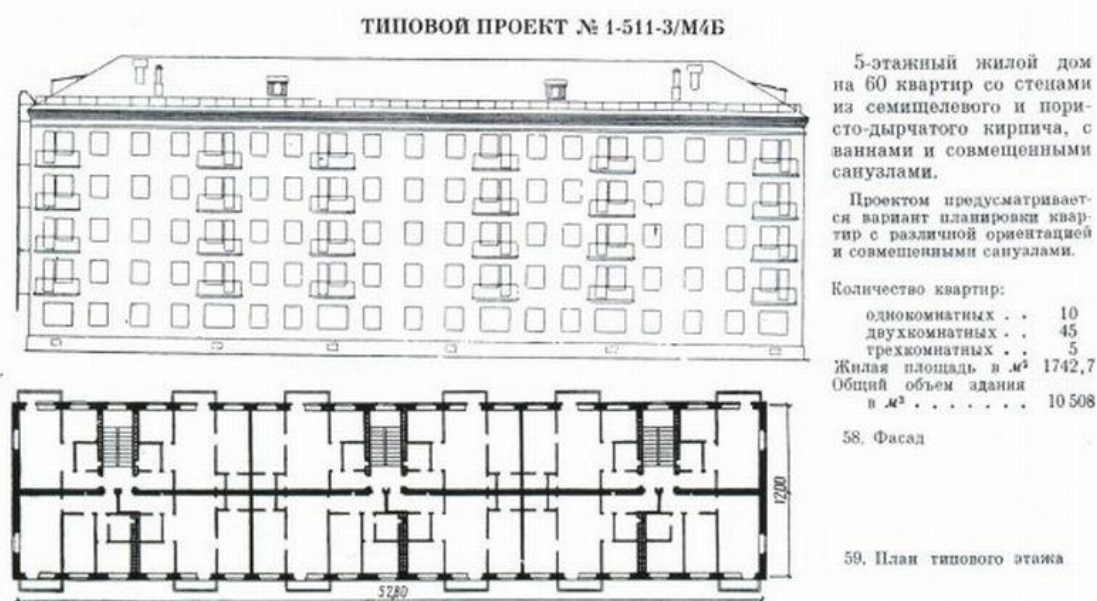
План и фасад 5-этажного жилого дома по типовому проекту №1-511-3/М4Б [14]
